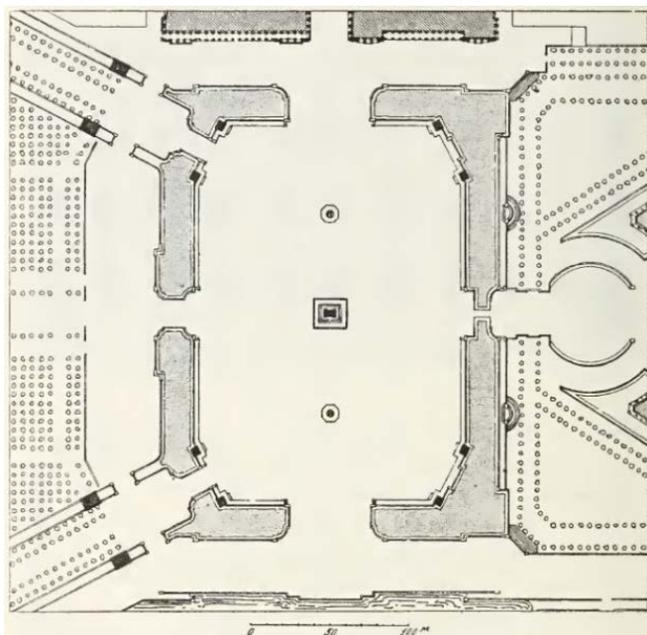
Planta da place de la Concorde, Paris (fonte:GUADET, 1910).
